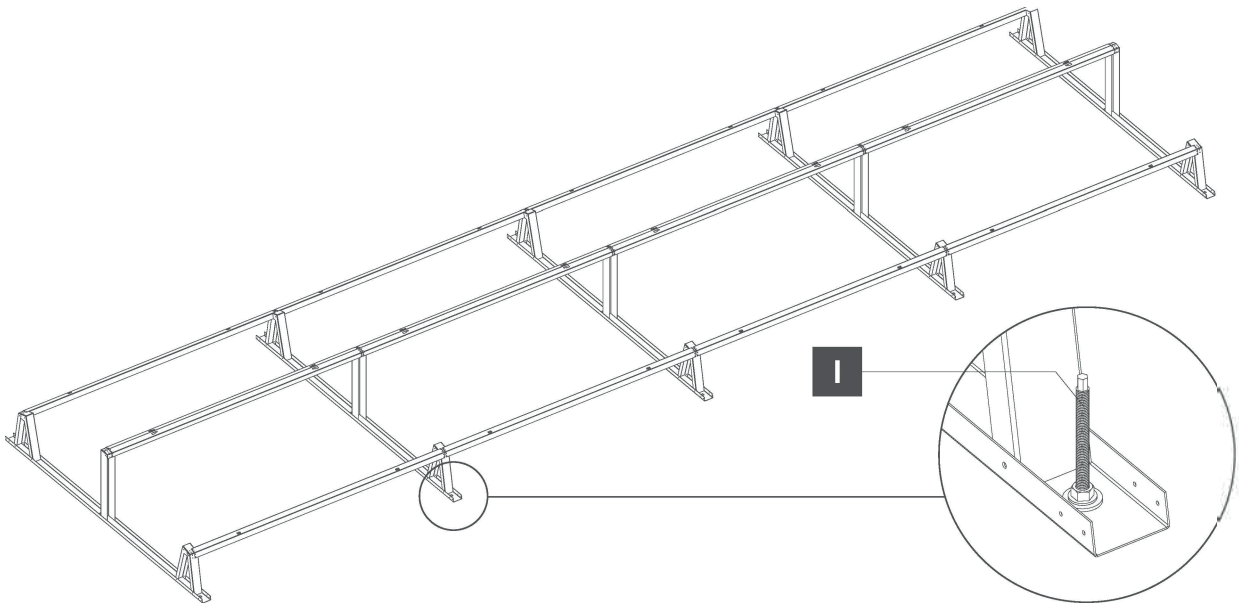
zeigt die Befestigung der Halterung am Montagedreieck
